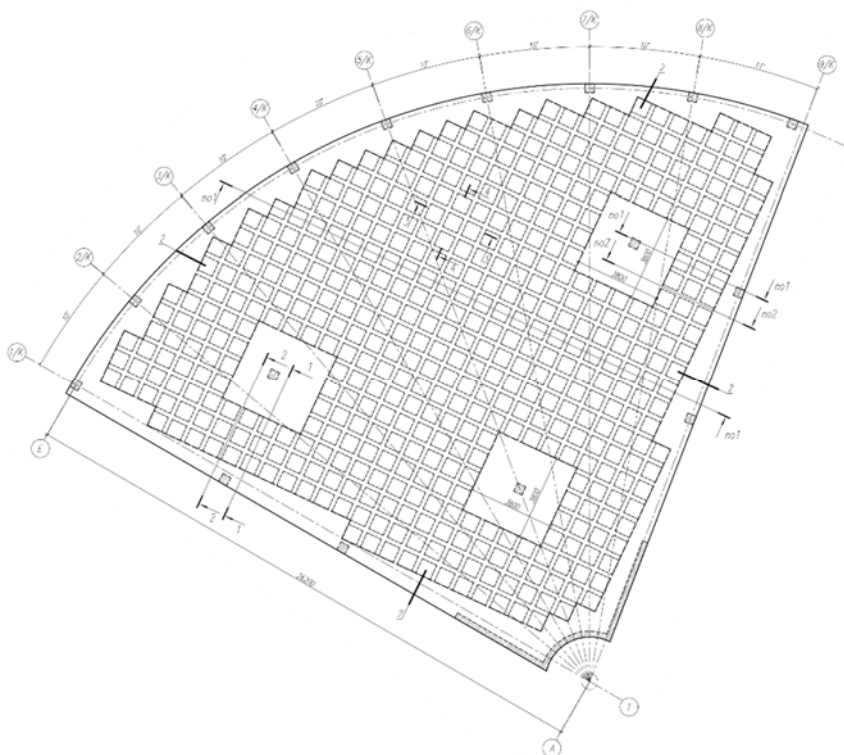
Конструктивное решение 1 – кессонное перекрытие
